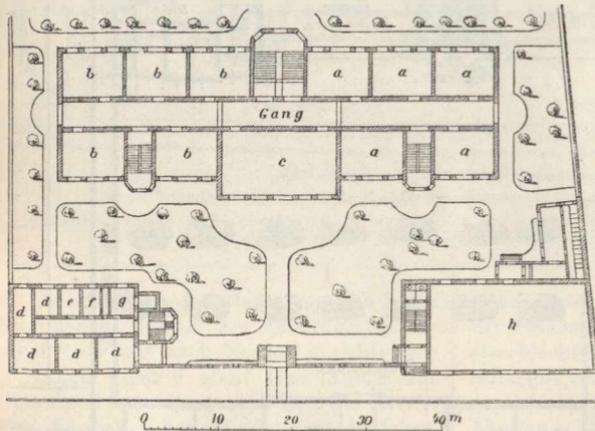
Lageplan und Grundriß der Gemeindeschule in der Glogauerstraße in Berlin.
